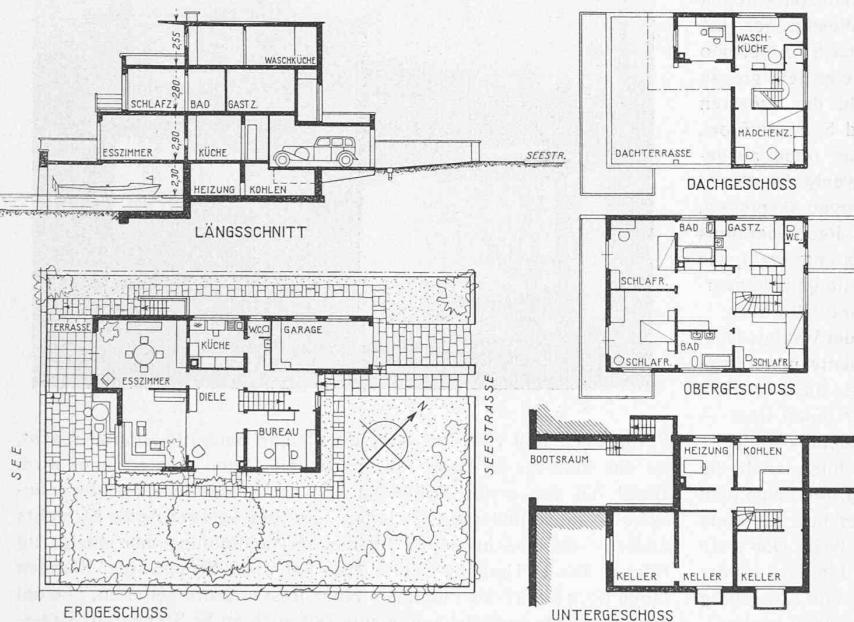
Lageplan, Grundrisse und Längsschnitt. — Massstab 1 : 400.
